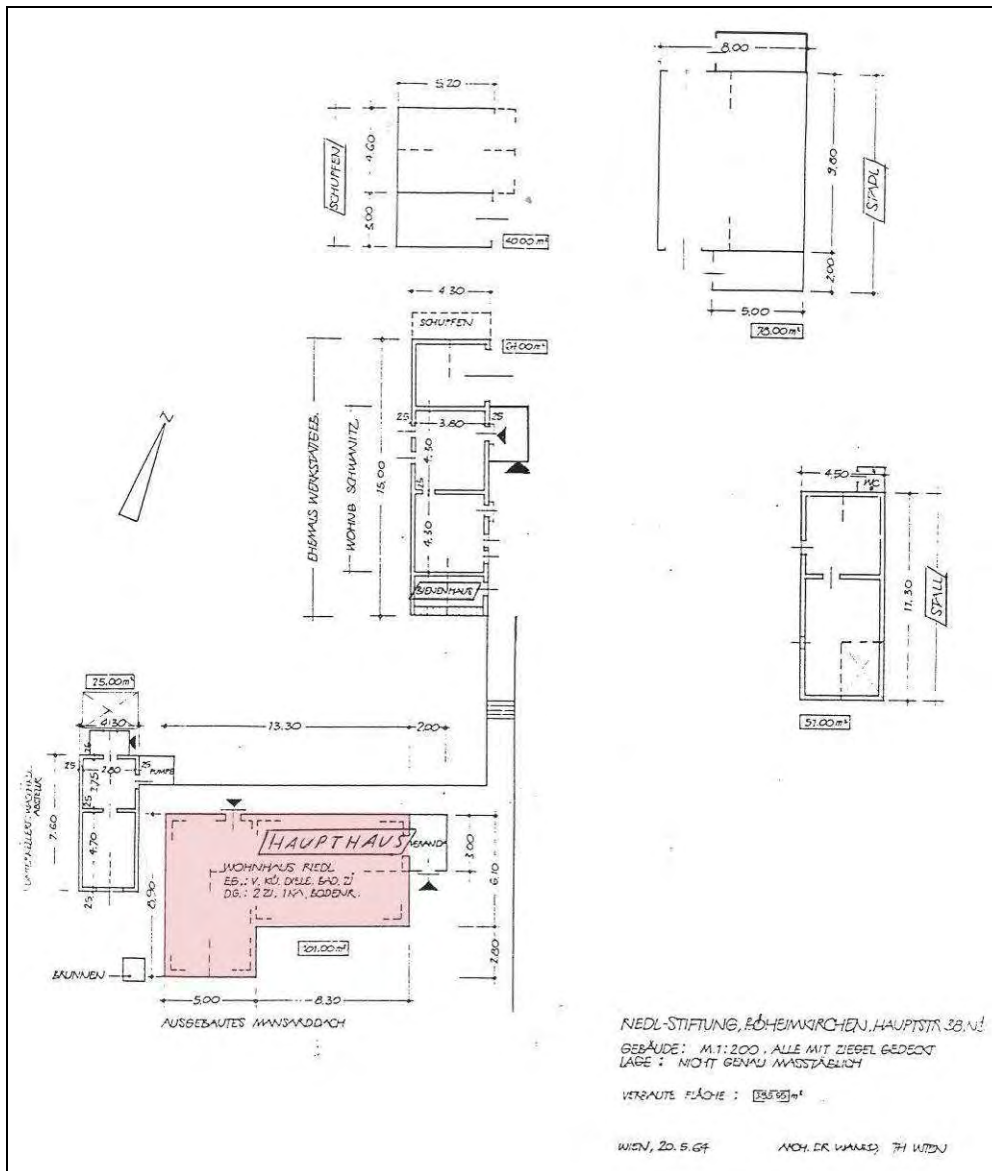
Lageplan des Sanierungsobjekts im Bestand
